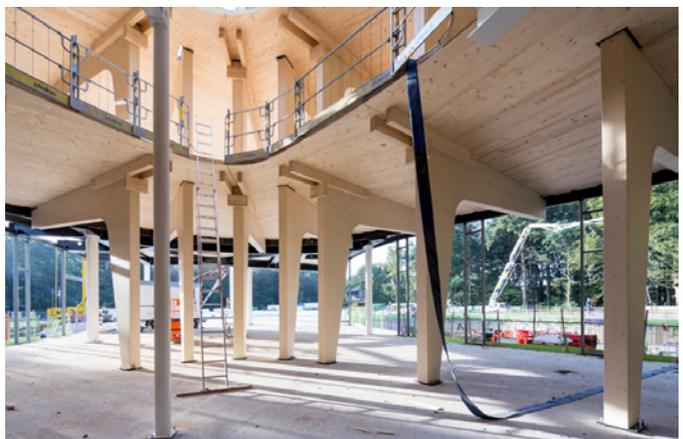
Montage tragendes Stützensystem aus Brettschichtholz mit Brettsperrholzdecken; © Carel van Hees
